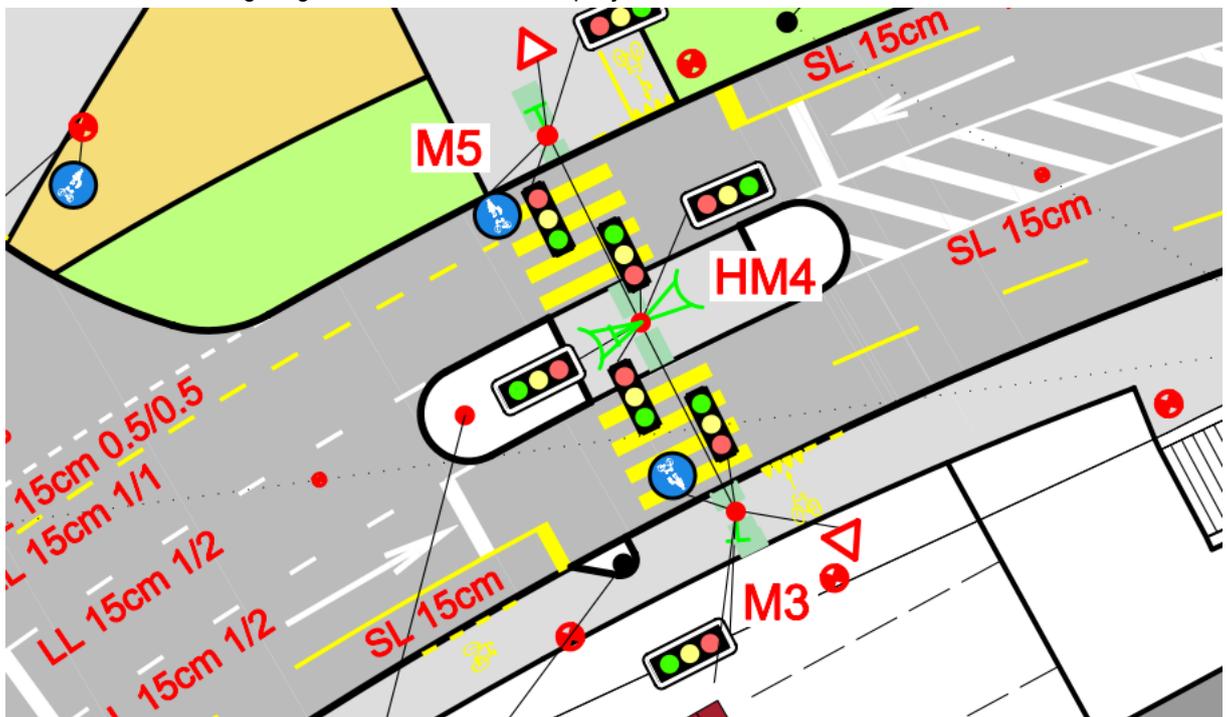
Ausschnitt Markierungsplan Fussgängerquerung Bachstrasse (SH_009)
